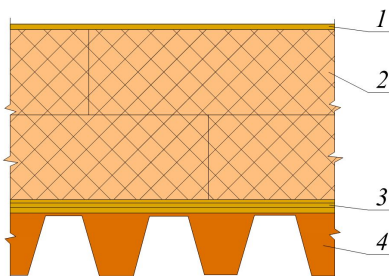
Конструкция покрытия кровли из стальных листов: 1 – наружное покрытие; 2 – тепловая изоляция; 3 – пароизоляция; 4 – гофрированный стальной лист
